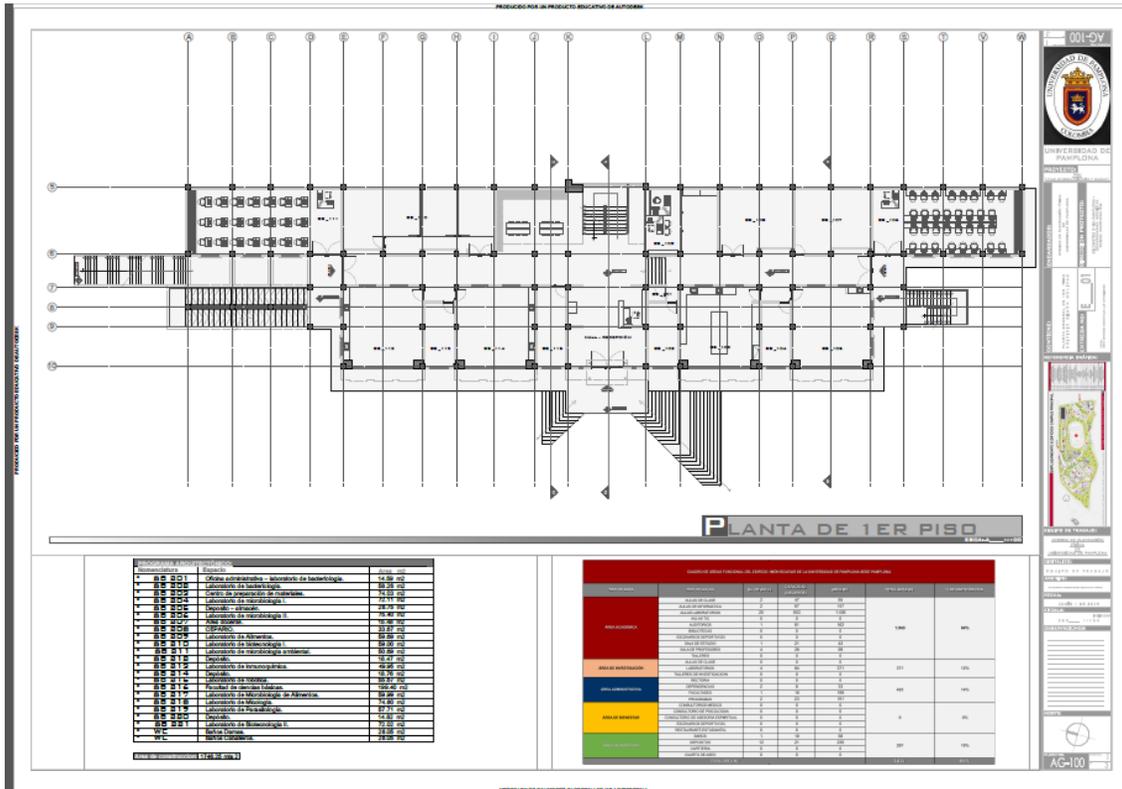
Planimetría edificio Simón Bolívar, Elaboración Oficina de Planeación física.
